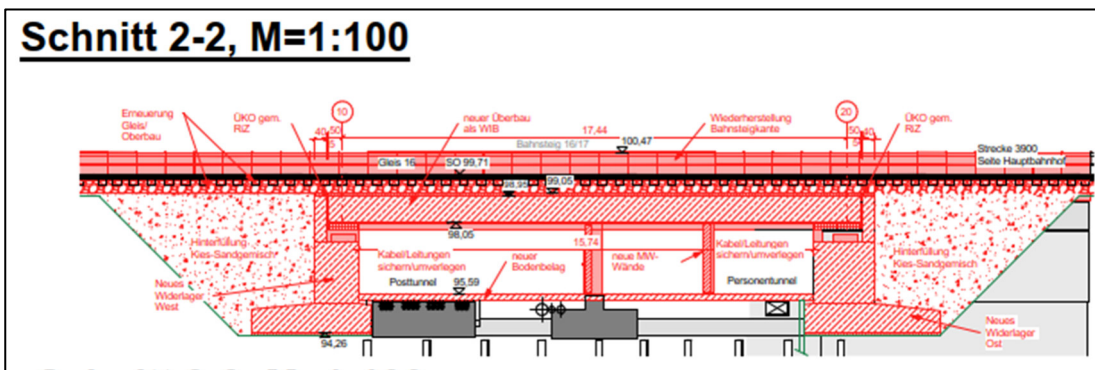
Schnitt durch den geplanten Neubau [U2]
